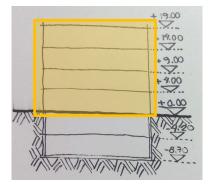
Área en la que se encuentran las columnas de menor sección 40x40cm
